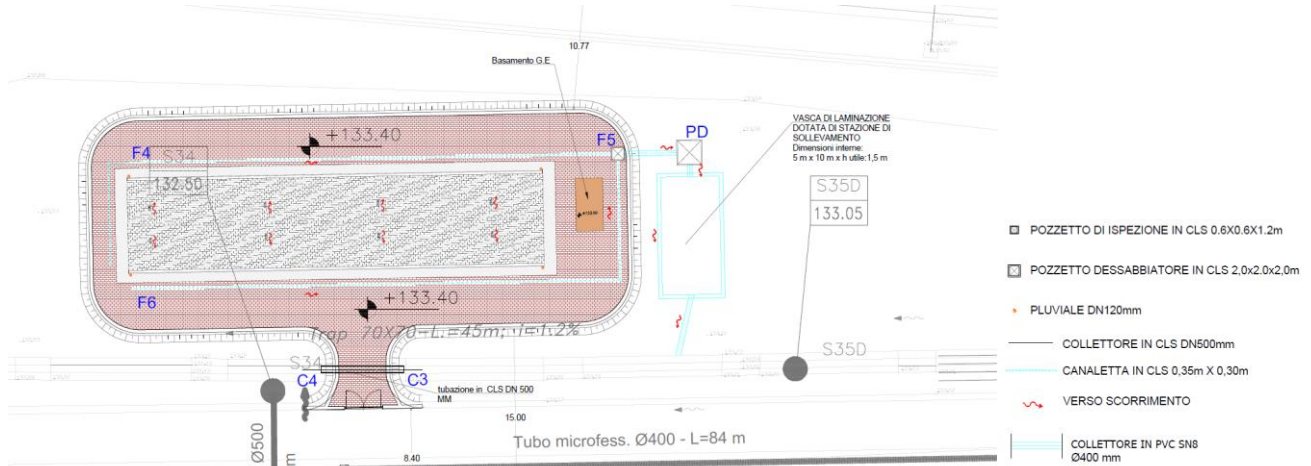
Planimetrica di smaltimento acque meteoriche – Fabbricato FA02 - Stralcio elaborato IN1M10D26PZFA0200001B
